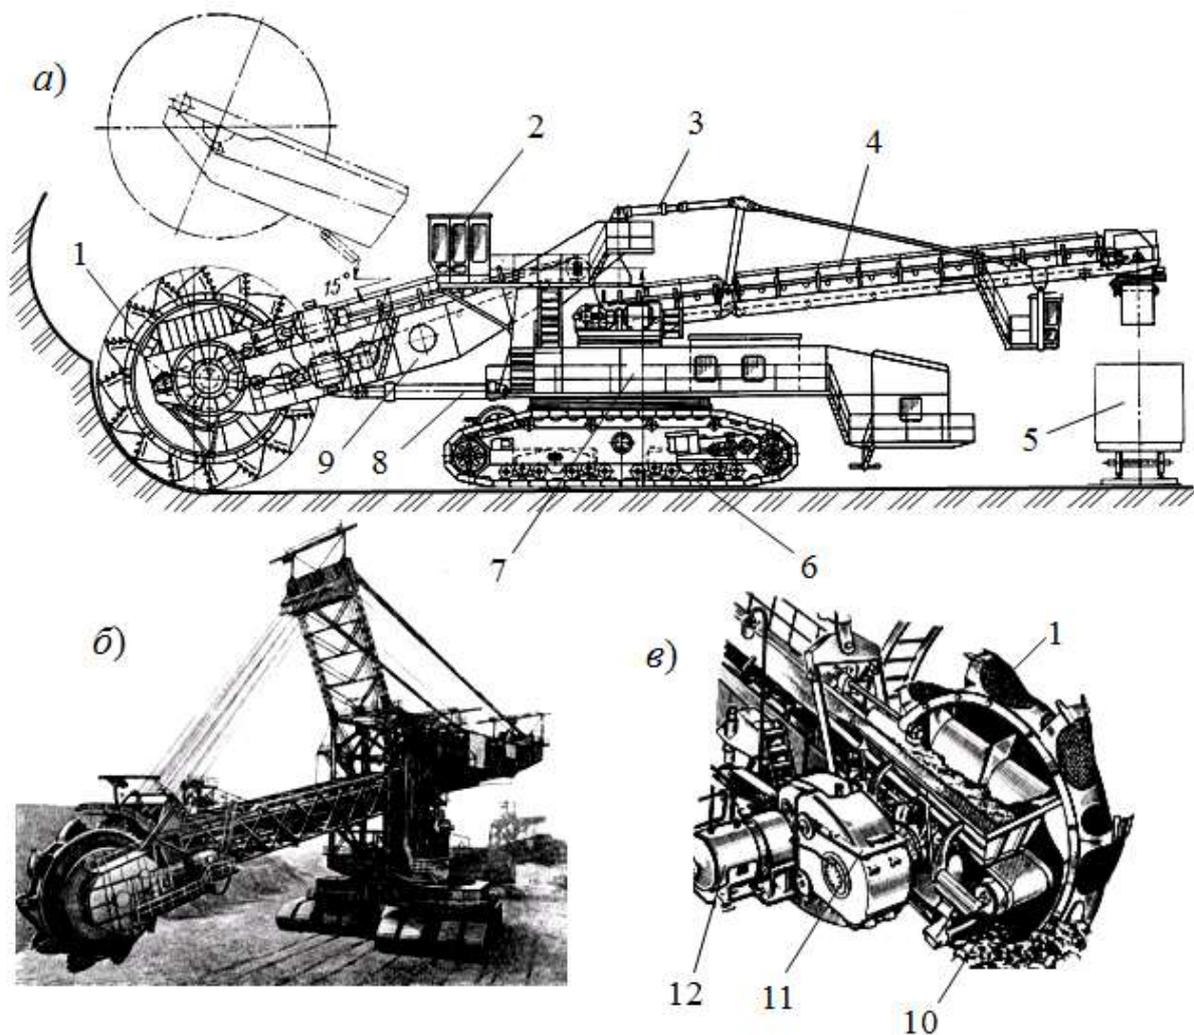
Многоковшовые экскаваторы поперечного копания: а- конструктивные схемы; б- фоторисунок; в- роторные рабочий орган; 1-ковшовый ротор; 2-пульт управления; 3-полистпась; 4-транспортер; 5-вагон; 6-гусеничный ход; 7-поворотные платформа; 8-гидроцилиндр; 9-рама ротора; 10-транспортер ротора; 11-редуктор; 12-электродвигатель.
